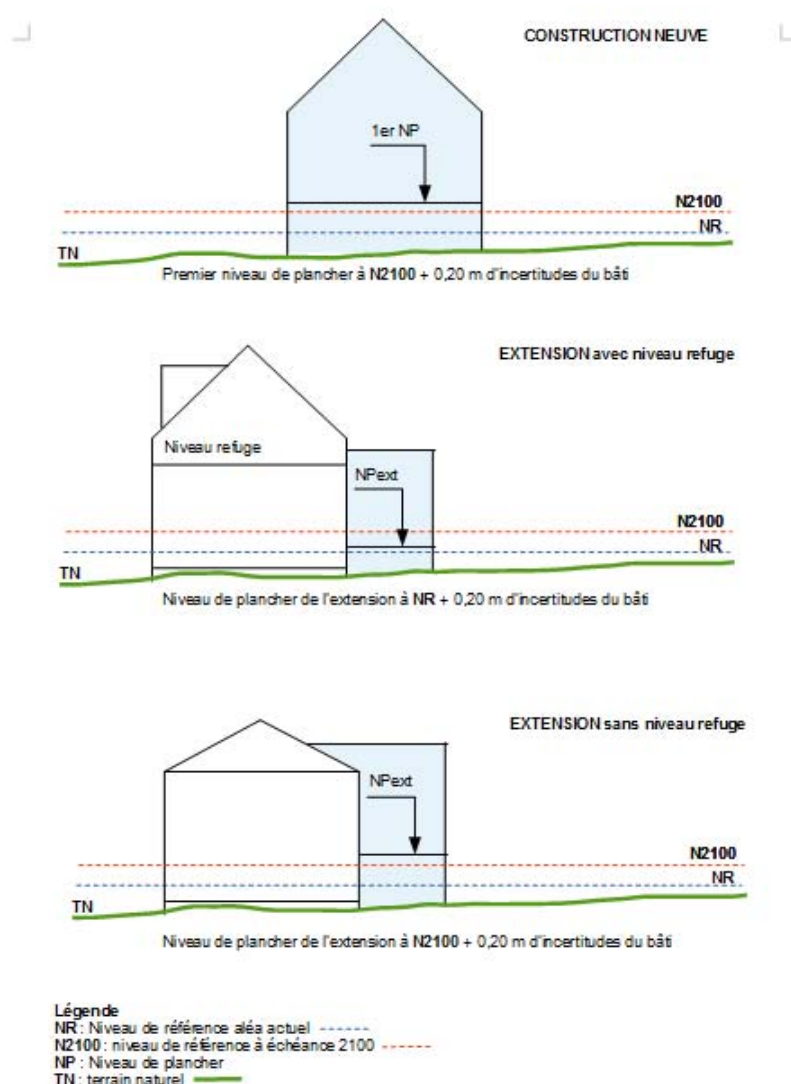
Exemple de définition de la cote du niveau plancher du projet à partir de la cote d'eau
